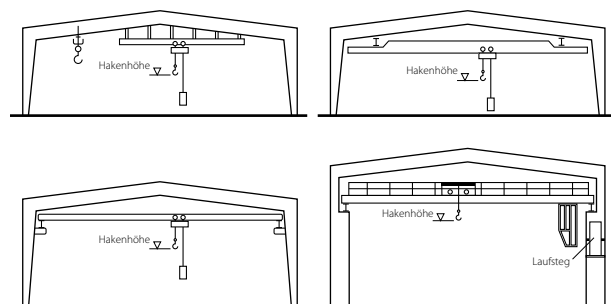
Grundsätzliche Ausführungsbeispiele für Hallenkran nach [18]
